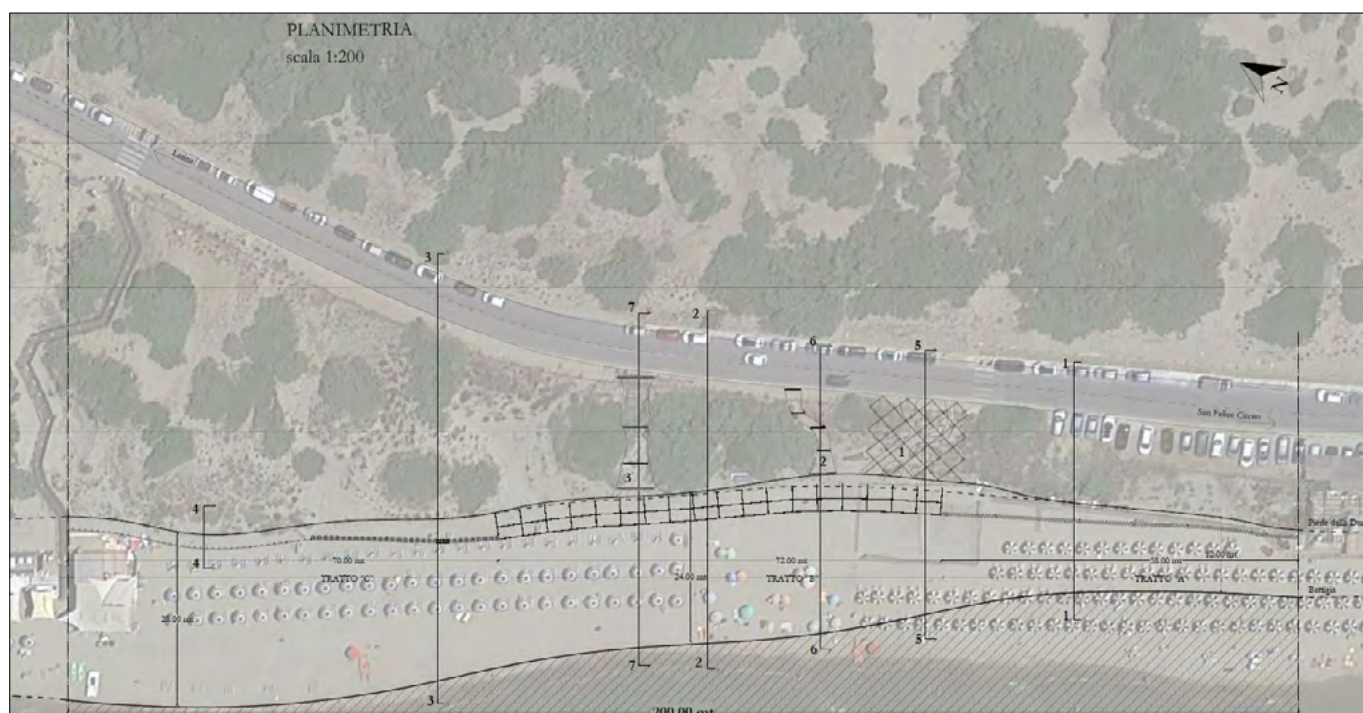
Planimetria del progetto (da F.Marsiali, 2020)
